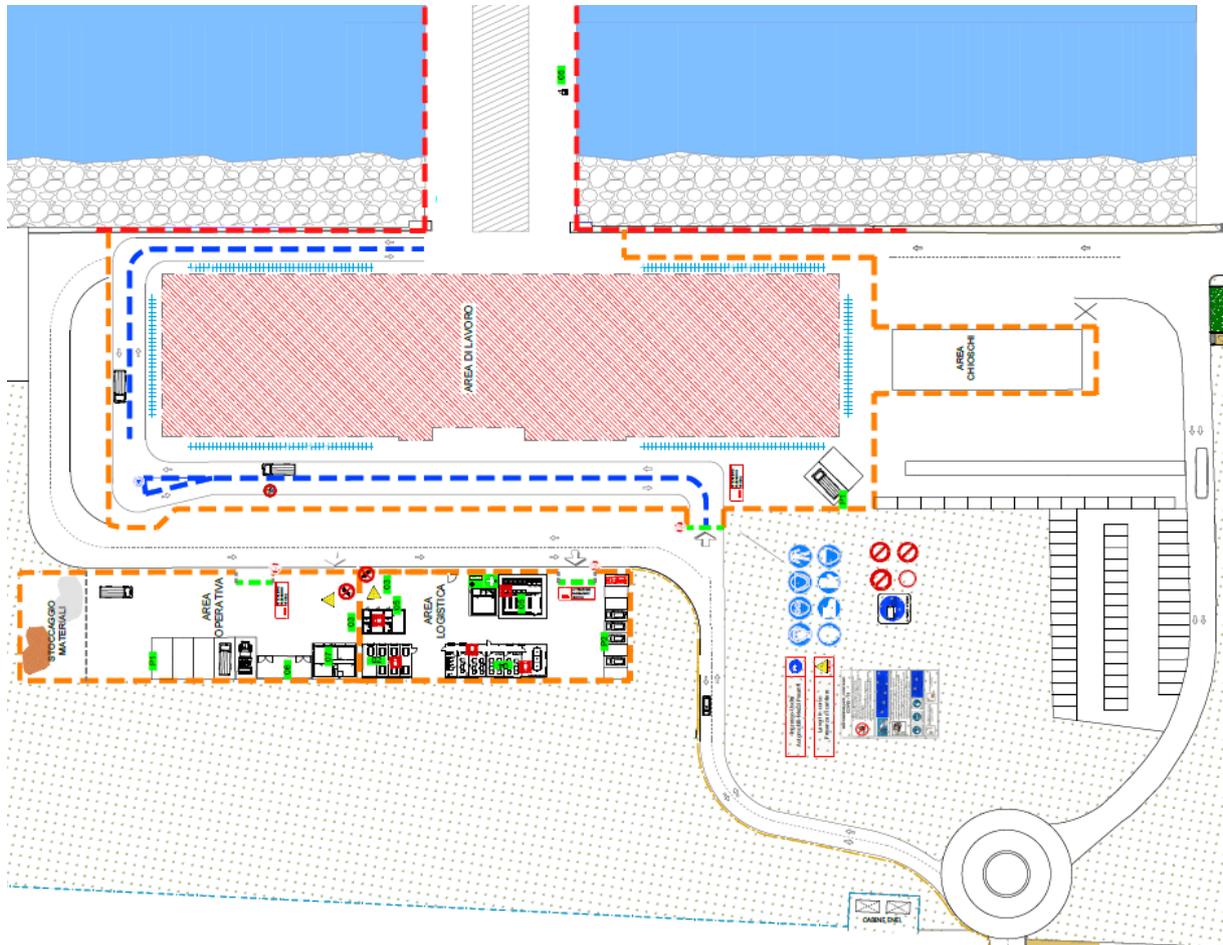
RAV PE-H4-Planimetria e Viabilità di Cantiere Fase 2
